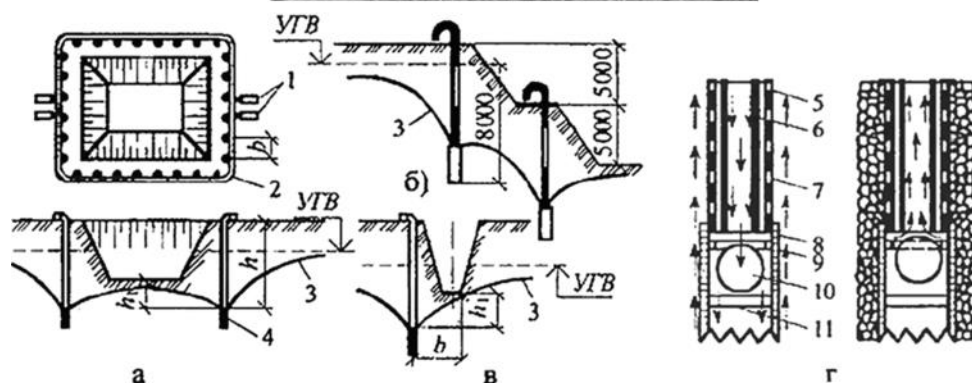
Схема иглофильтрового способа понижения уровня грунтовых вод: а – для котлована при одноярусном расположении иглофильтров; б – то же при двухъярусном их расположении; в – для траншеи; г – схема работы фильтрующего звена при погружении в грунт в процессе откачки воды;
